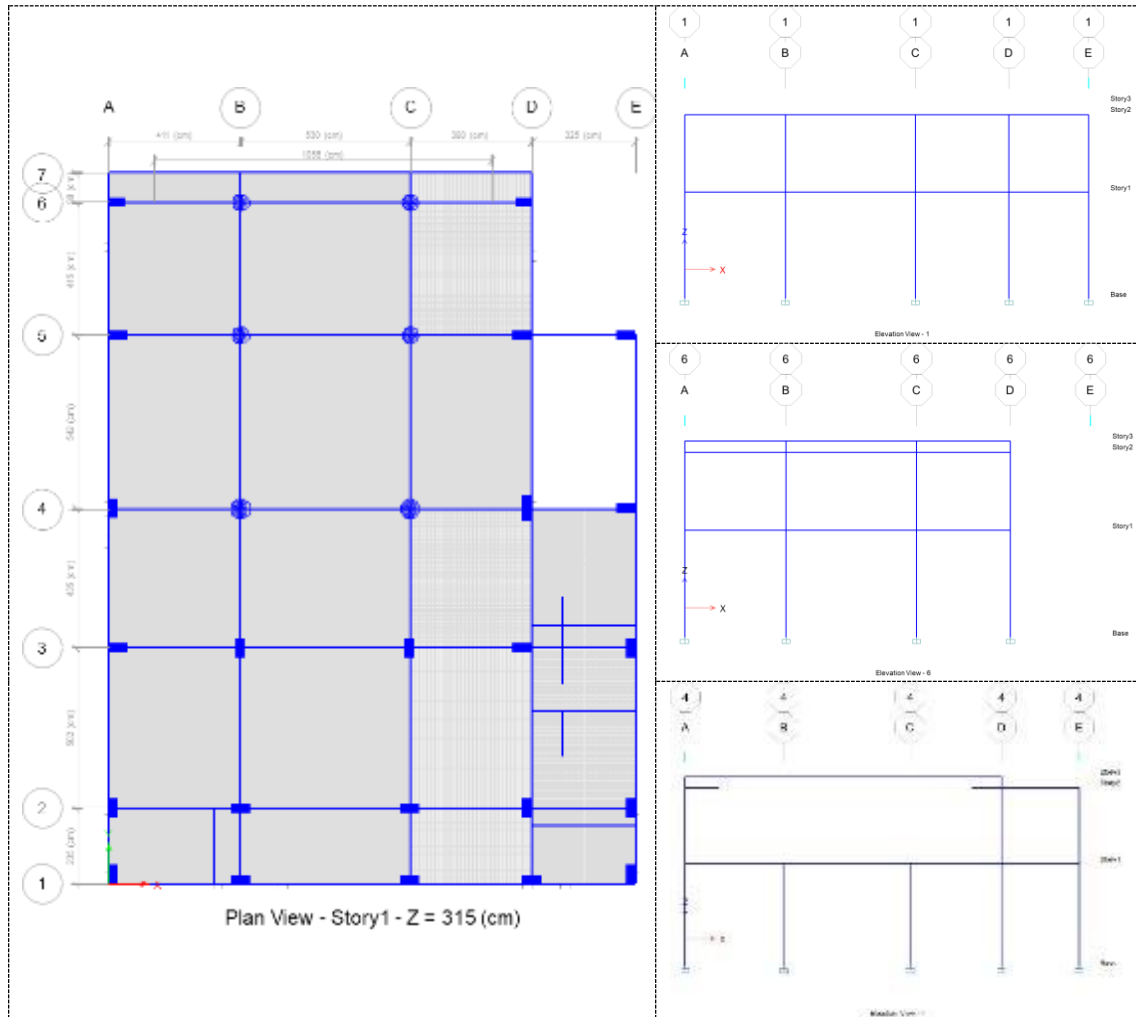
Propuesta 1, Modulo III, sistema aporricado (columnas y vigas)
